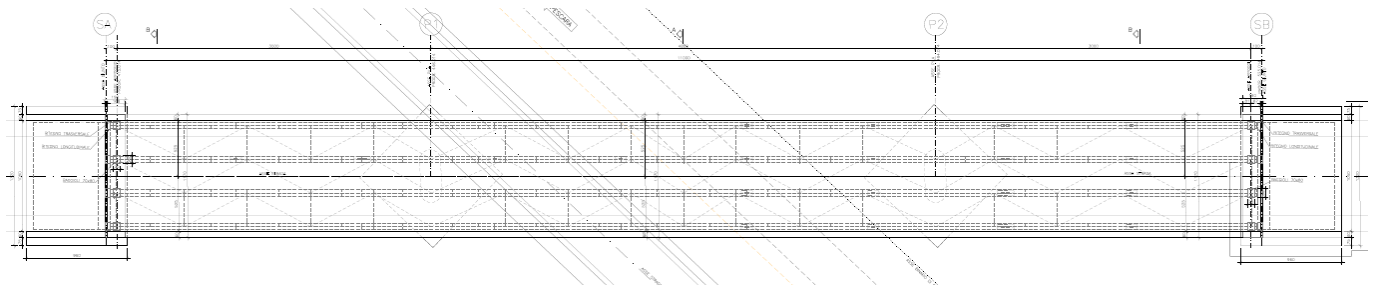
Profilo schematico - lato spalla SB
